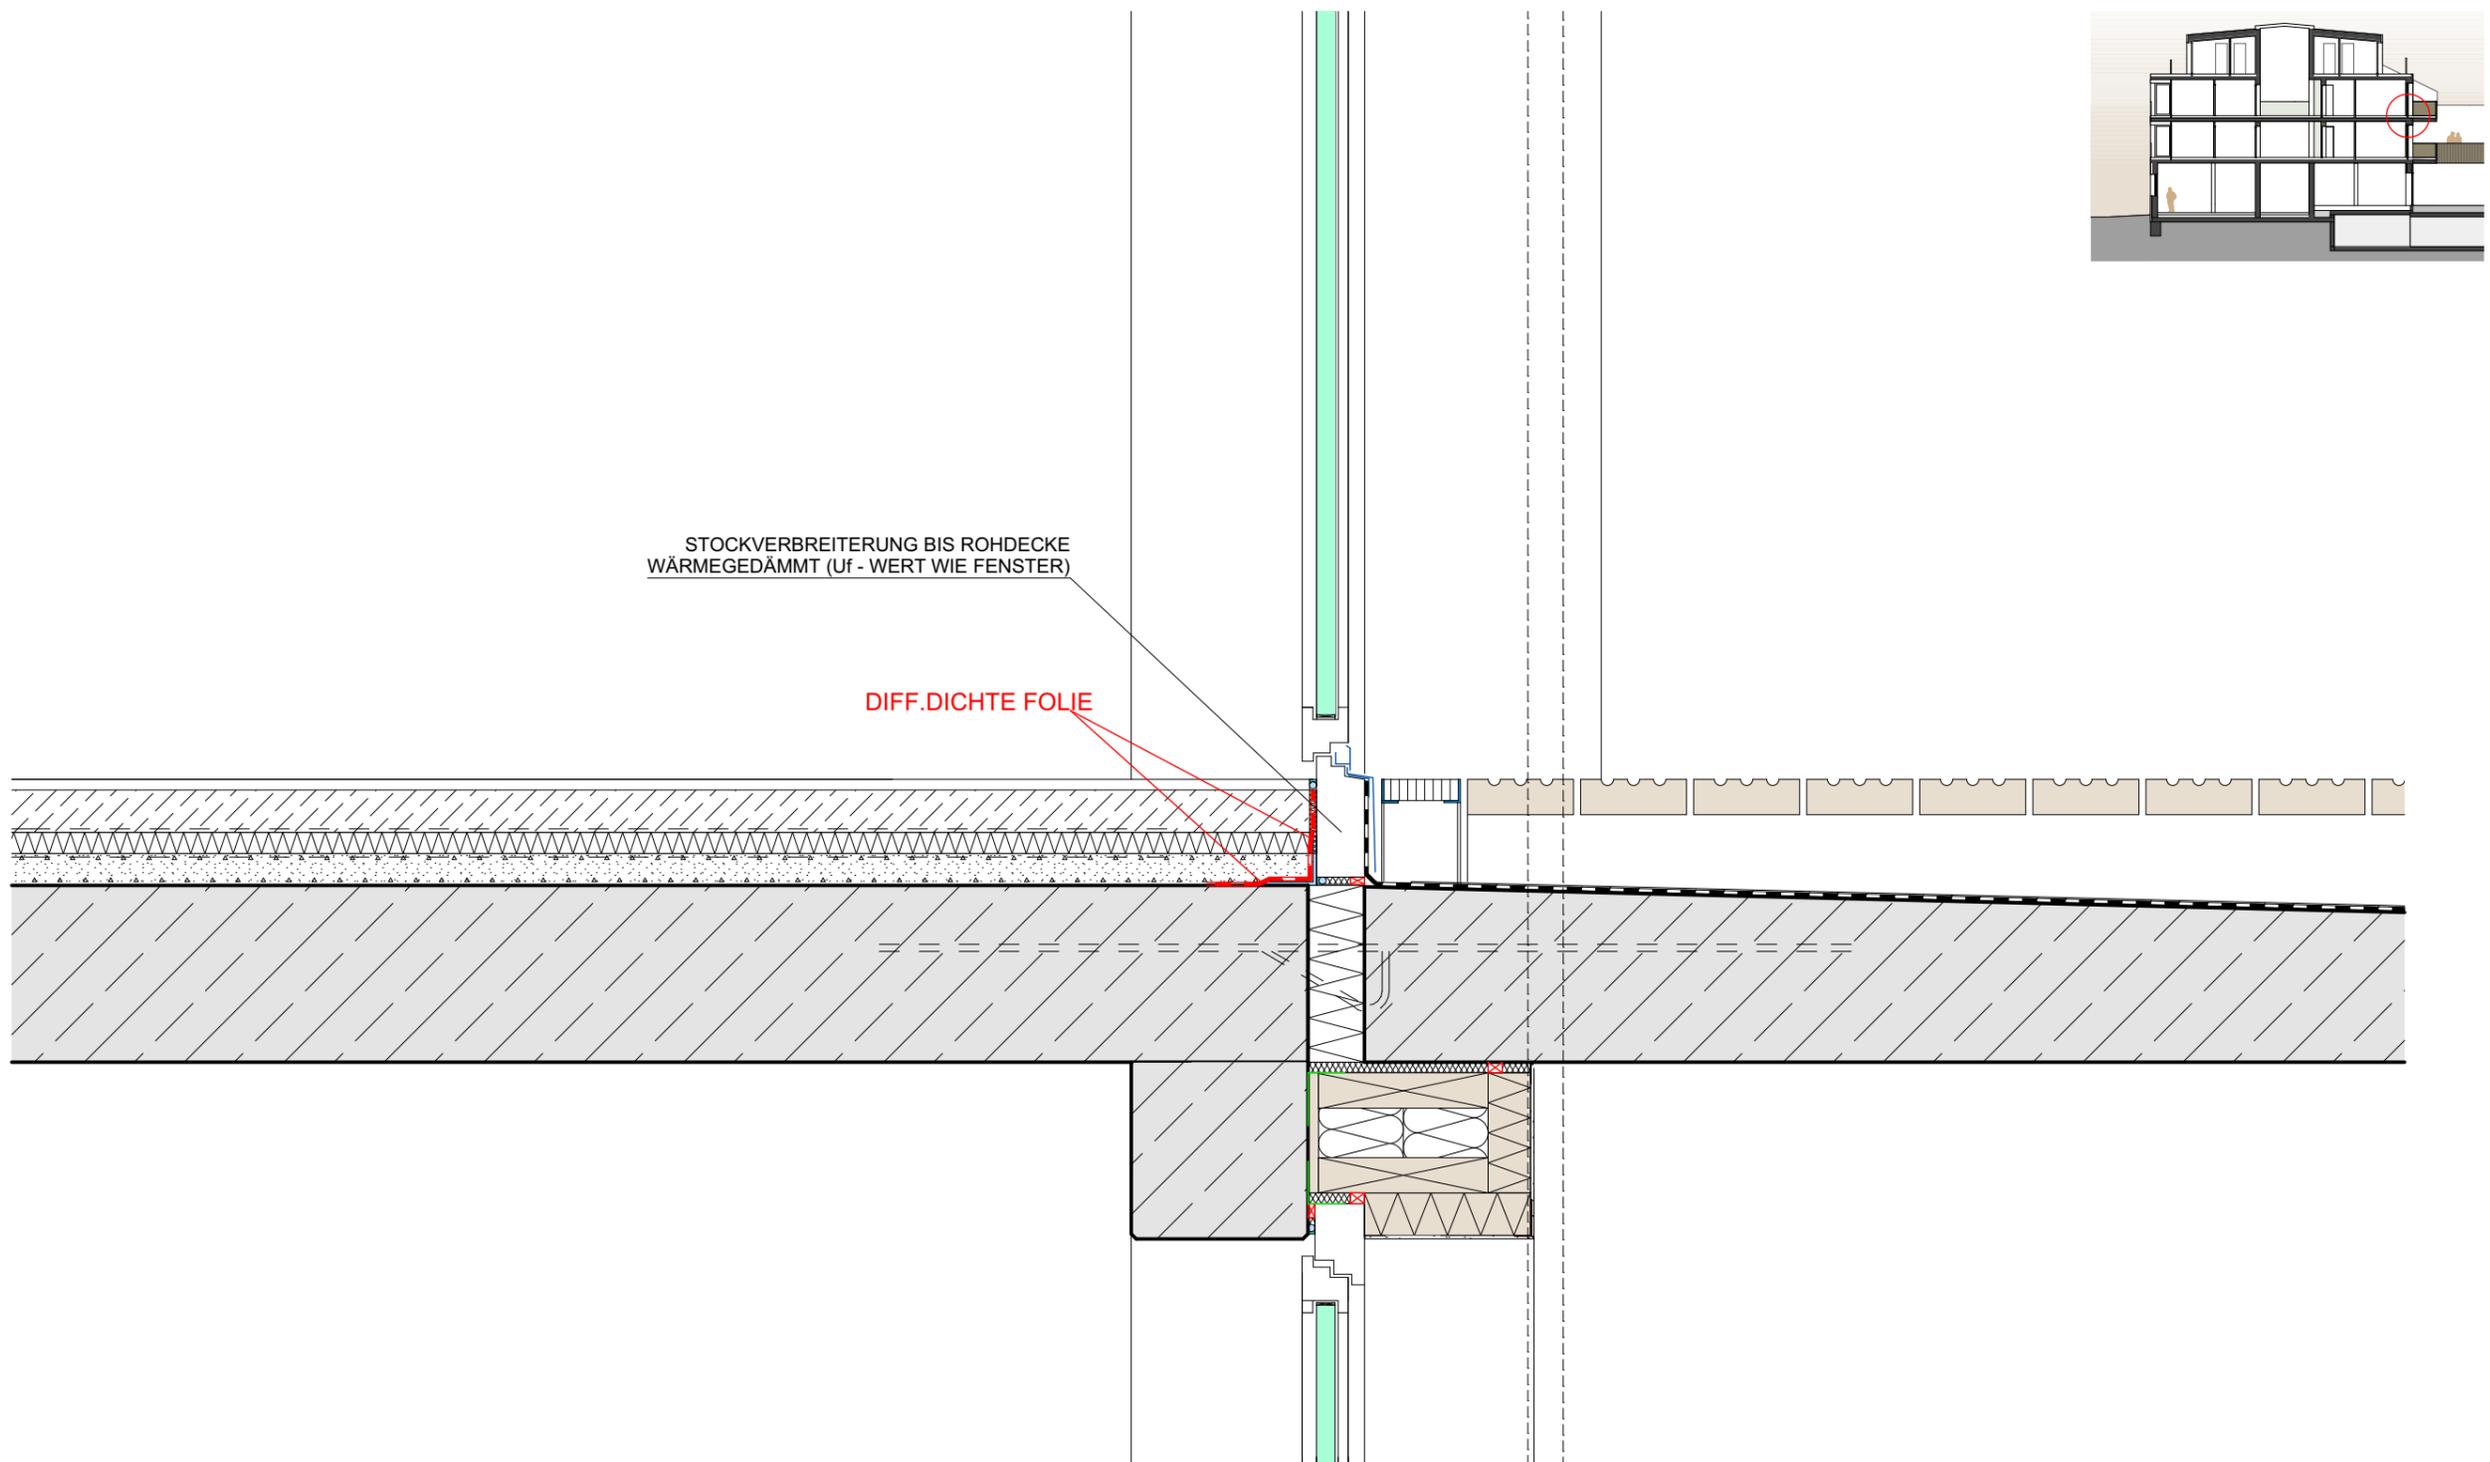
Bauteil 1: Anschluss Balkon1:10
